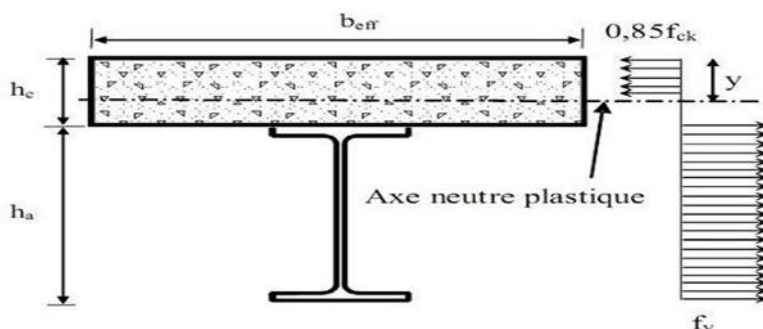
Axe neutre plastique de la poutre mixte dans la dalle
